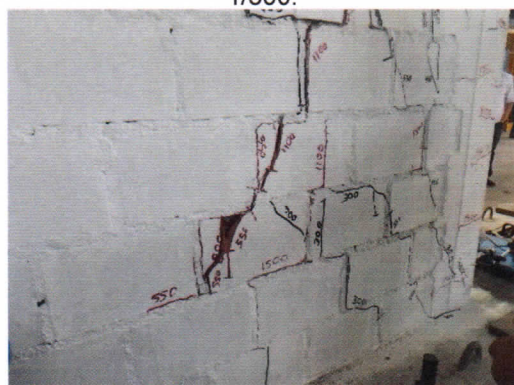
Formación de grietas diagonales en la parte inferior Este de la cara Sur para una distorsión de 1/300.
